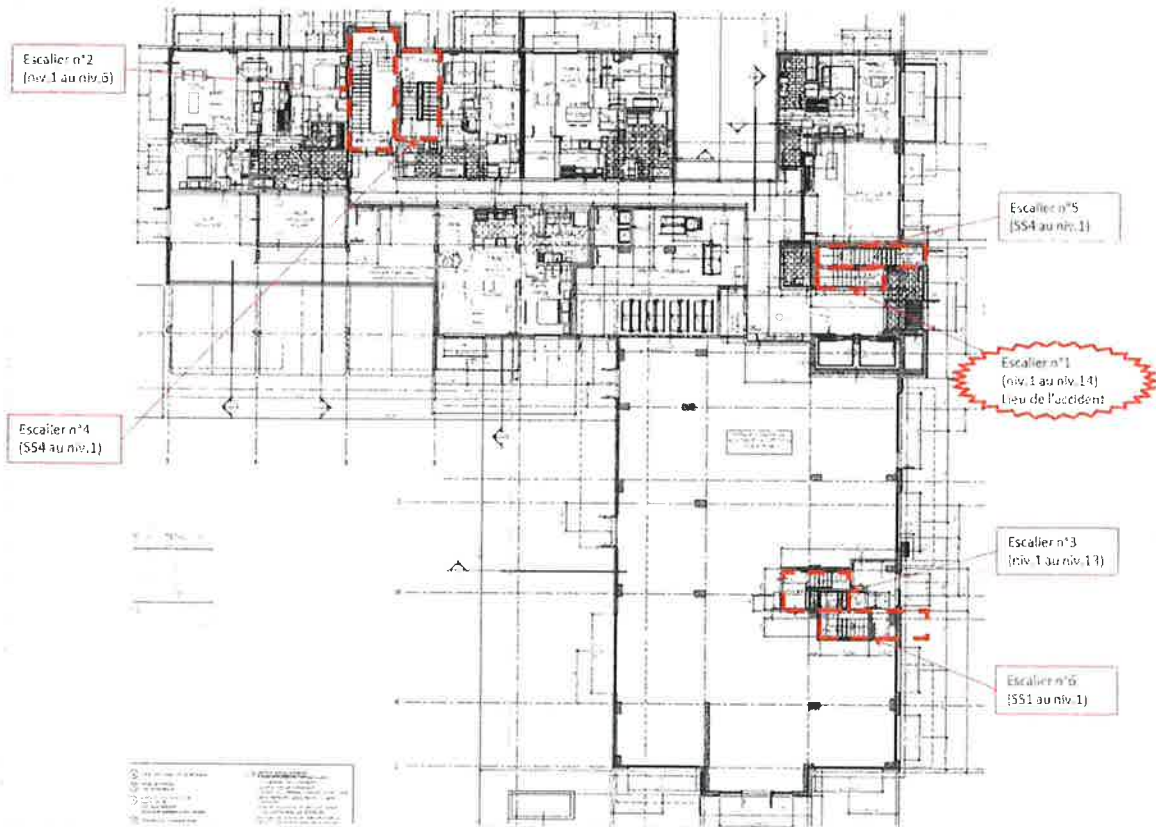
Localisation des escaliers sur le plan d'architecture Niveau 1 (RDC)
